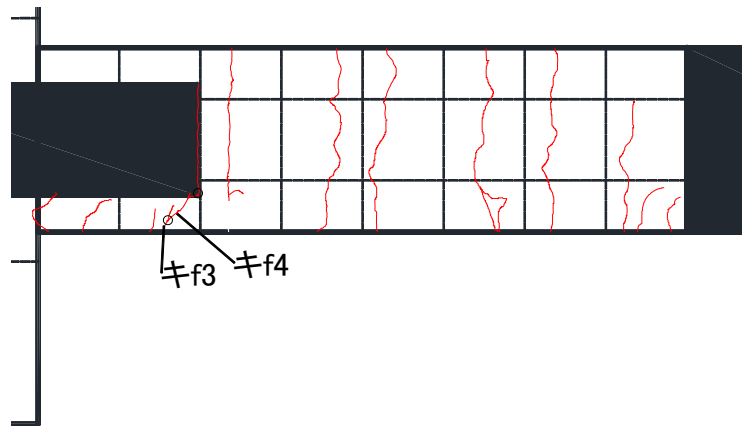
基礎梁ひび割れ幅測定位置 (試験体 DR-4 -7.0 サイクル 上面)
